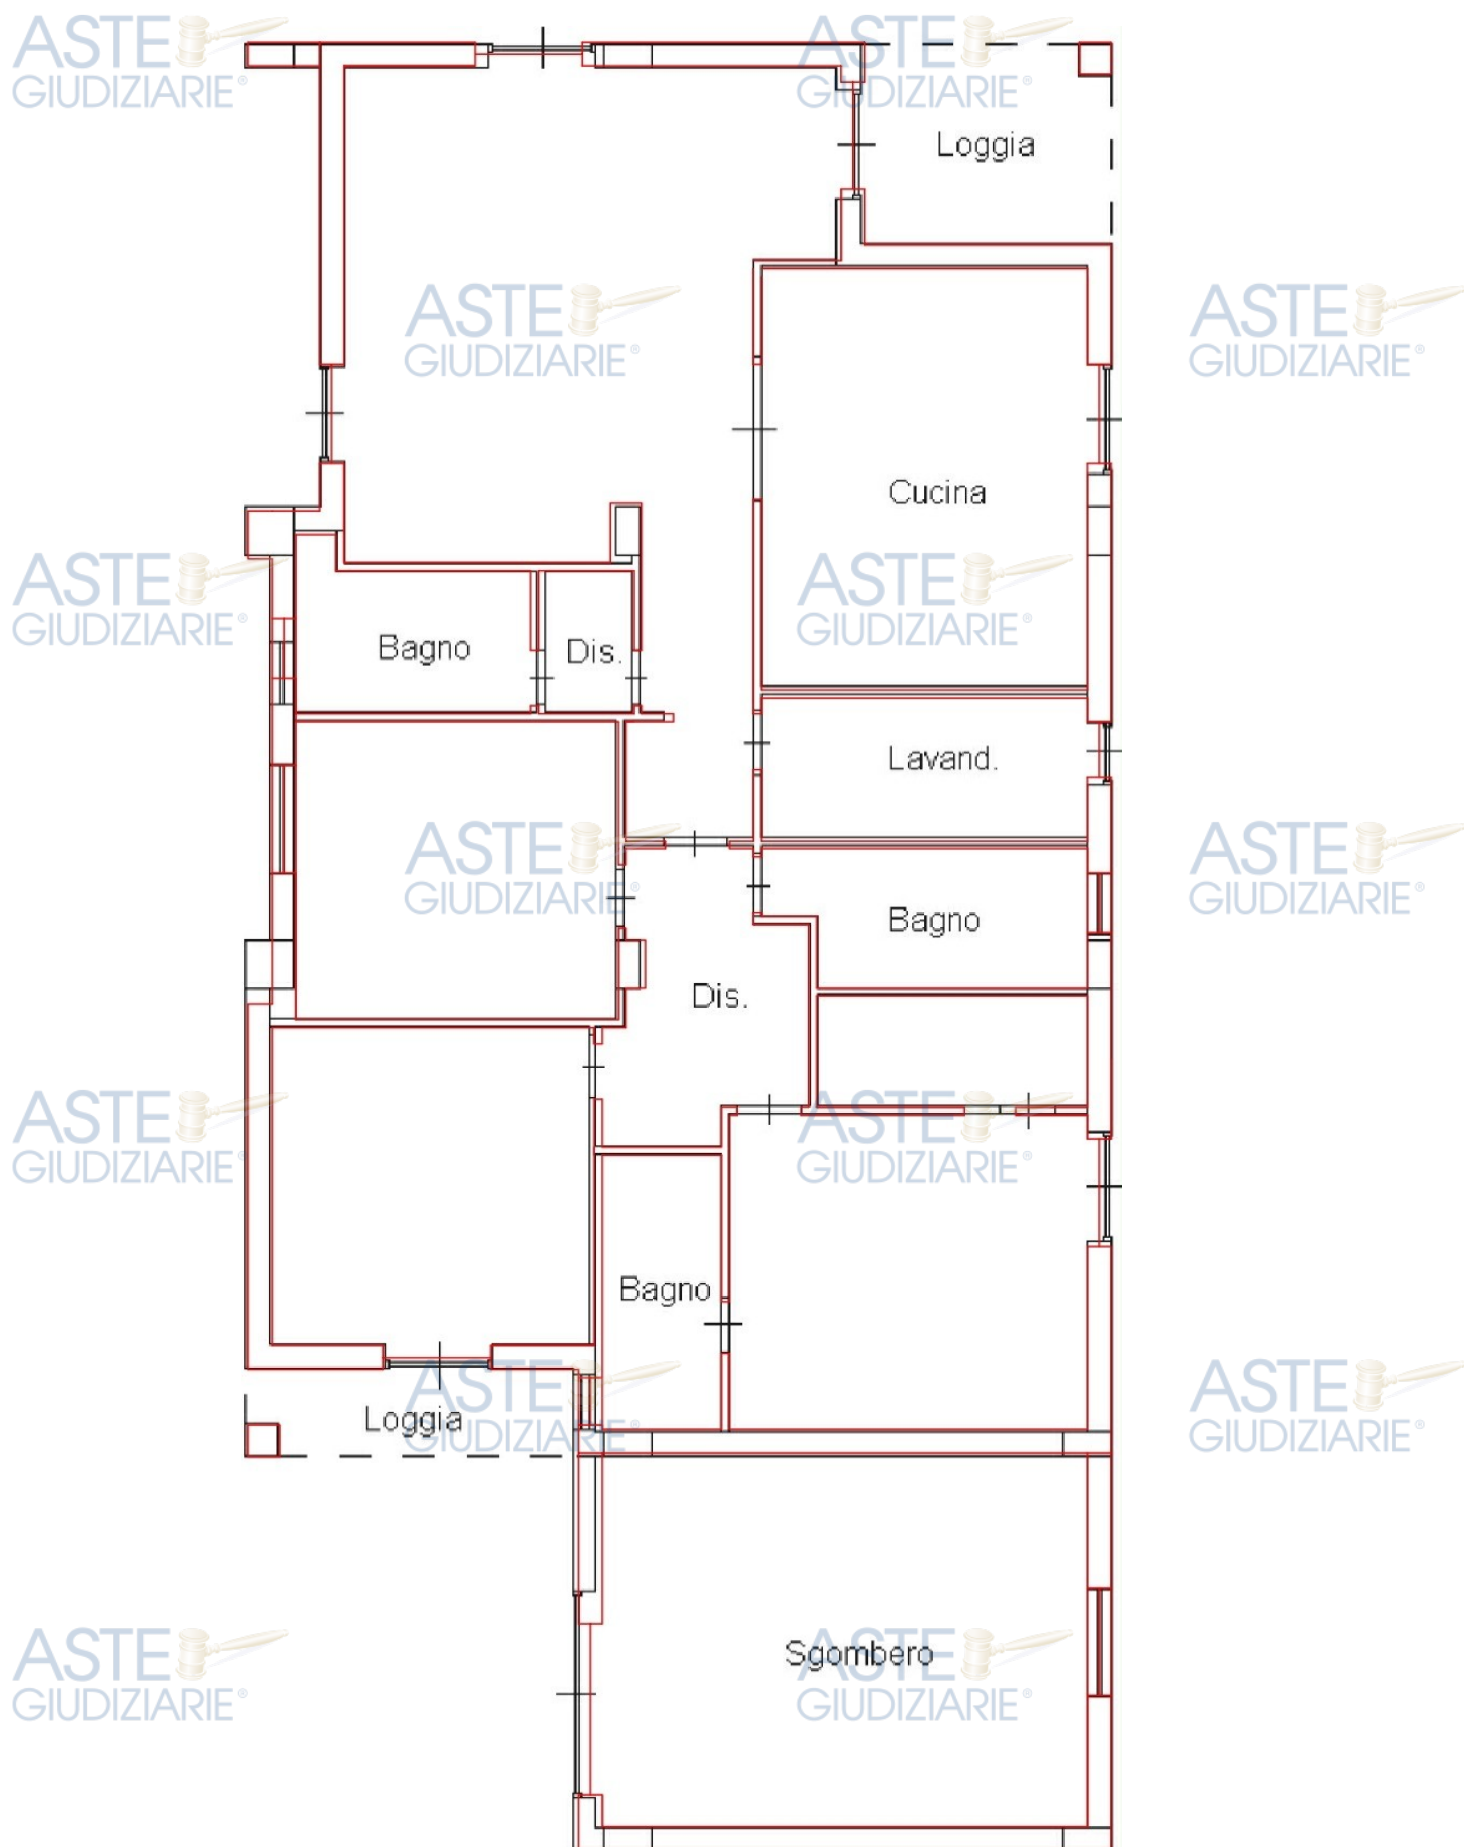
(sovrapposizione della reale planimetria con la planimetria catastale)
